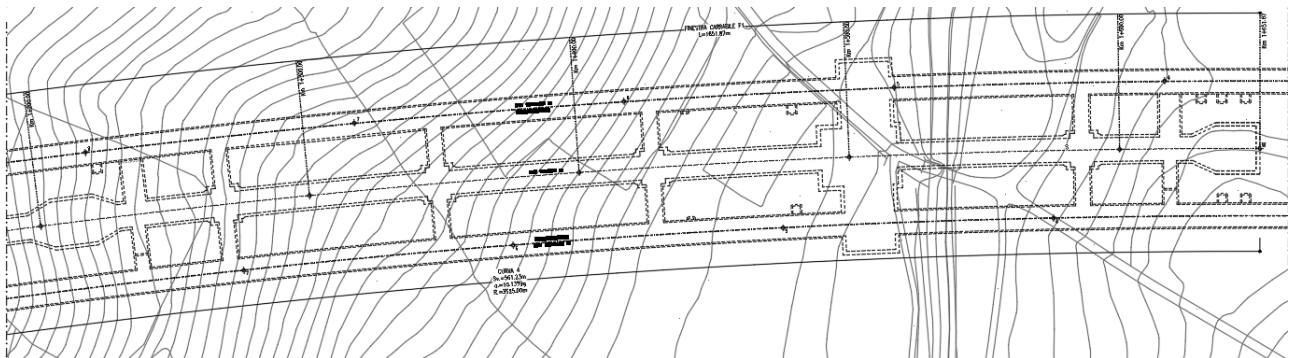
Schema planimetrico Punto Antincendio in galleria
